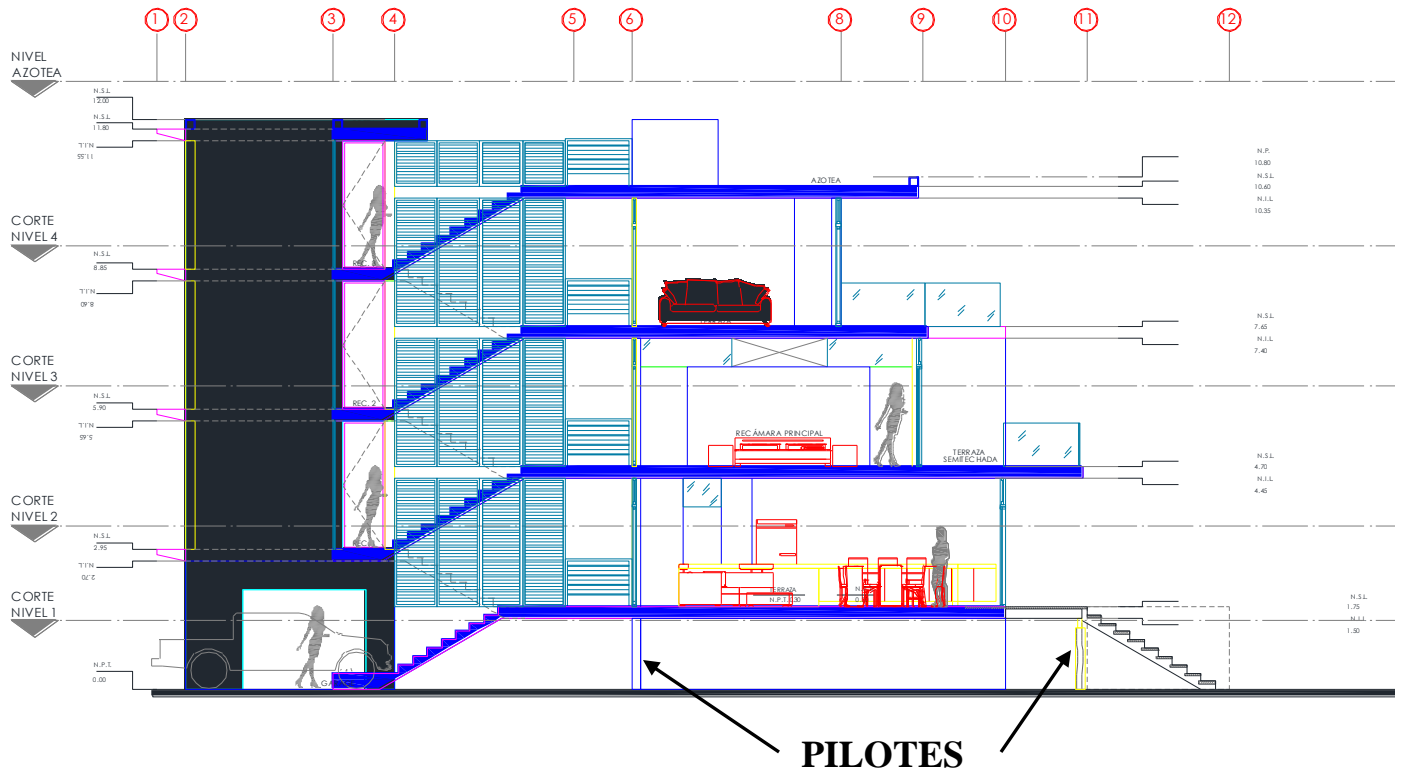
Piloteado de la edificación de las villas a establecer en el proyecto.
